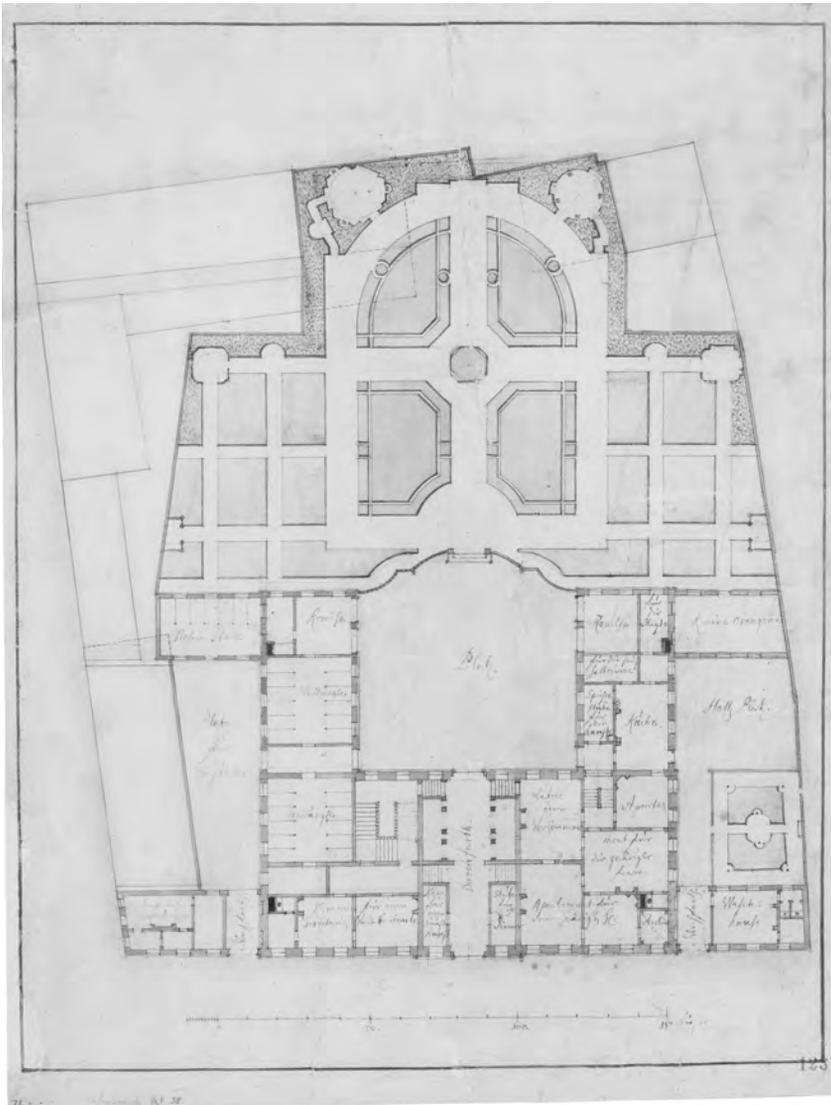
Münster, Nordkirchener Hof, Aegidiistraße 18-22, Grundriss und Plan, Gottfried Laurenz Pictorius
